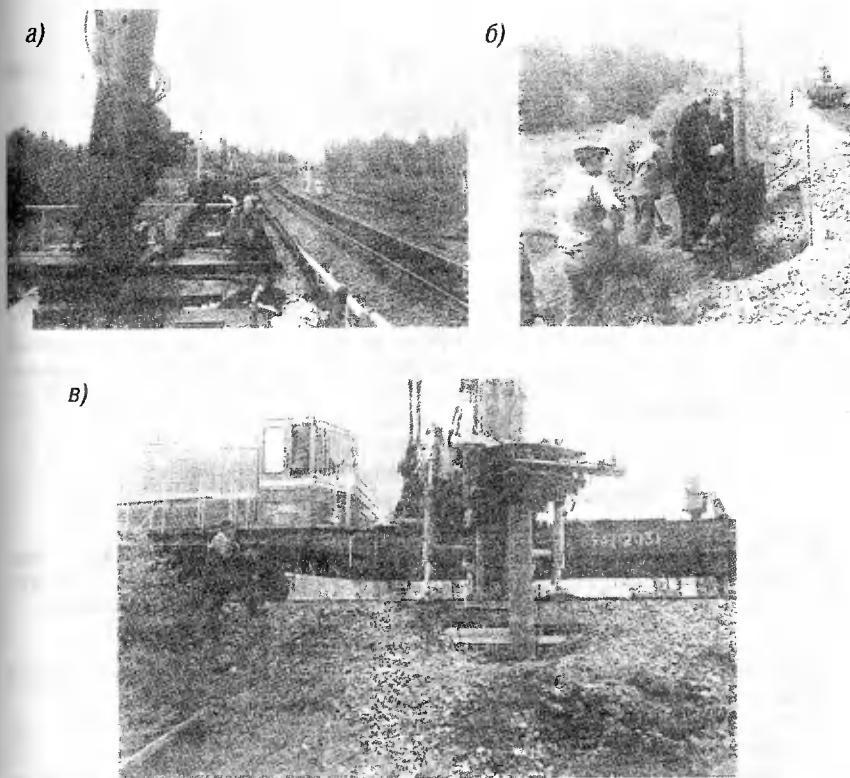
Механизированный комплекс по завинчиванию свай (а); агрегат по бурению лидирующей скважины (б); агрегат для завинчивания металлической сваи (в)
